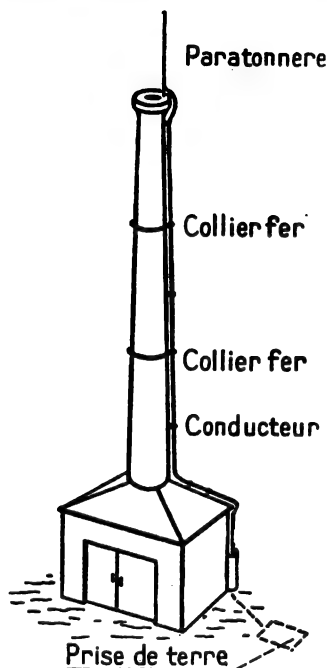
Protection d'une haute cheminée d'usine par un paratonnerre à pointe.
